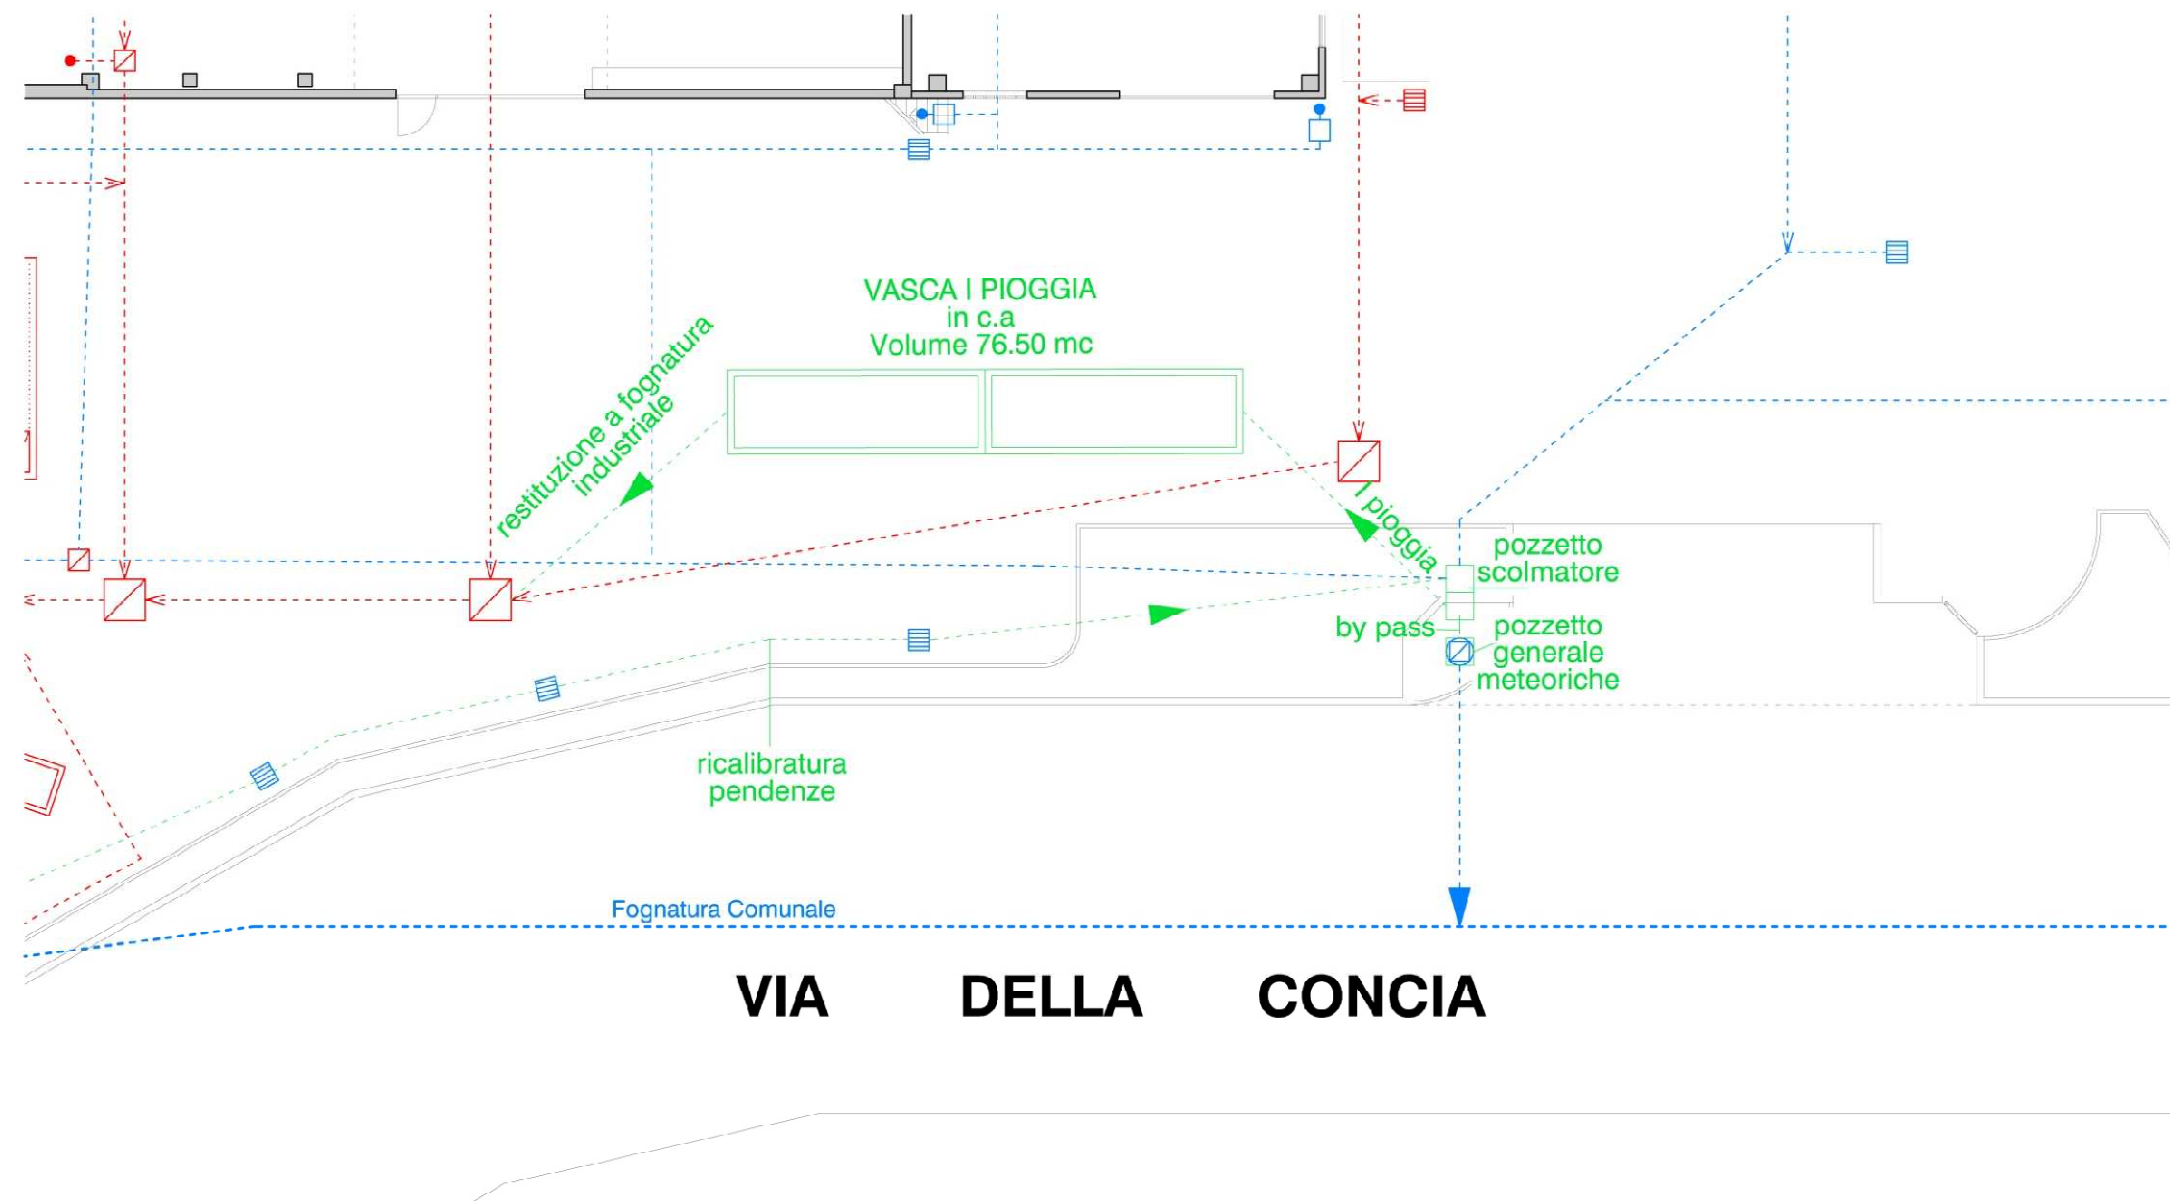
Stralcio planimetrico con descrizione degli ipotetici interventi di collegamento della vasca di I pioggia realizzata con manufatti prefabbricati in c.a.
